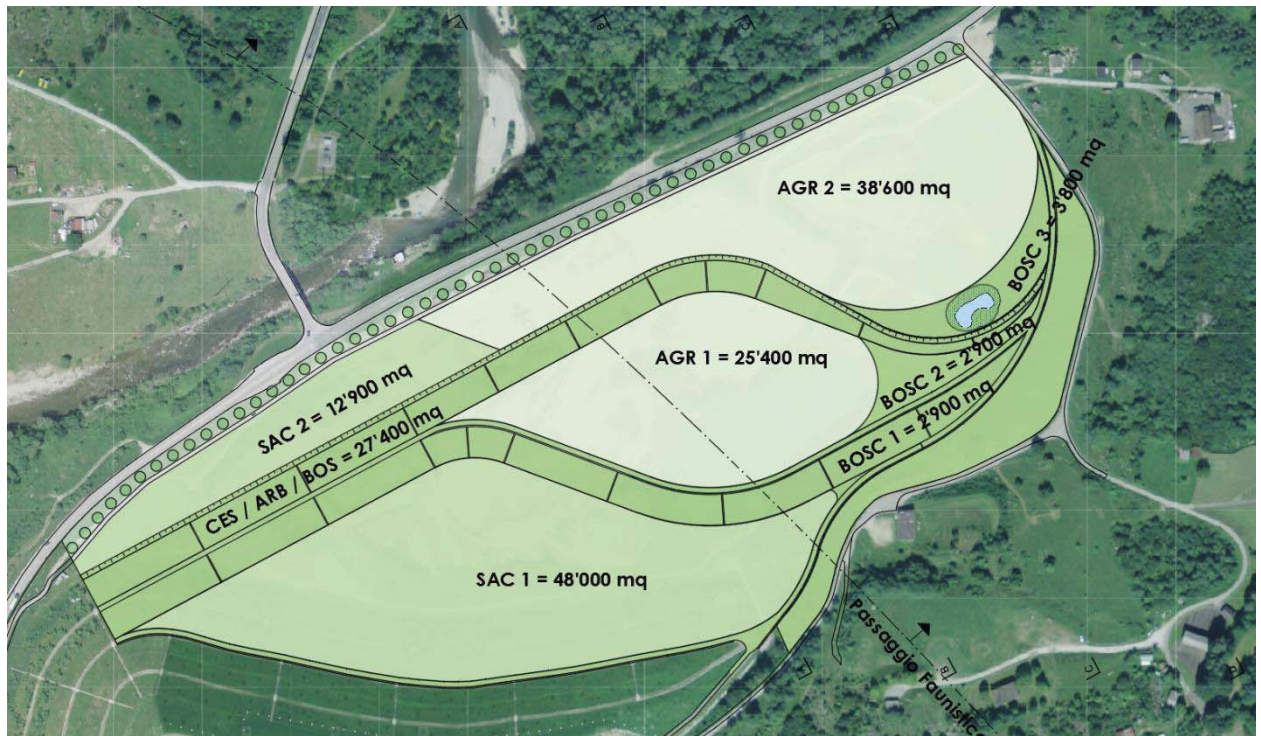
Variante 2: montaggio su immagine area situazione esistente
